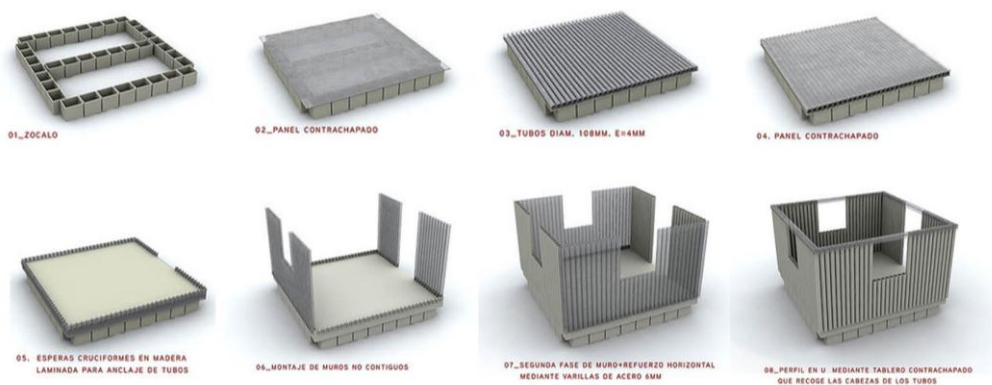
“Paper Log Houses” - Esquema explicativo da montagem das estruturas utilizadas no Japão.
